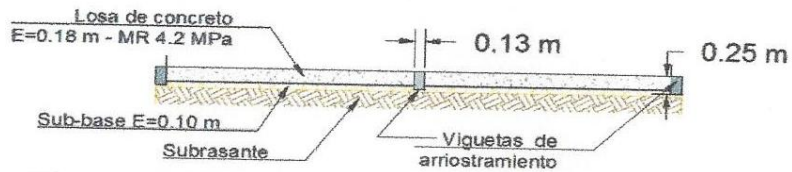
Vista en perfil longitudinal de los espesores de la estructura del pavimento del proyecto
